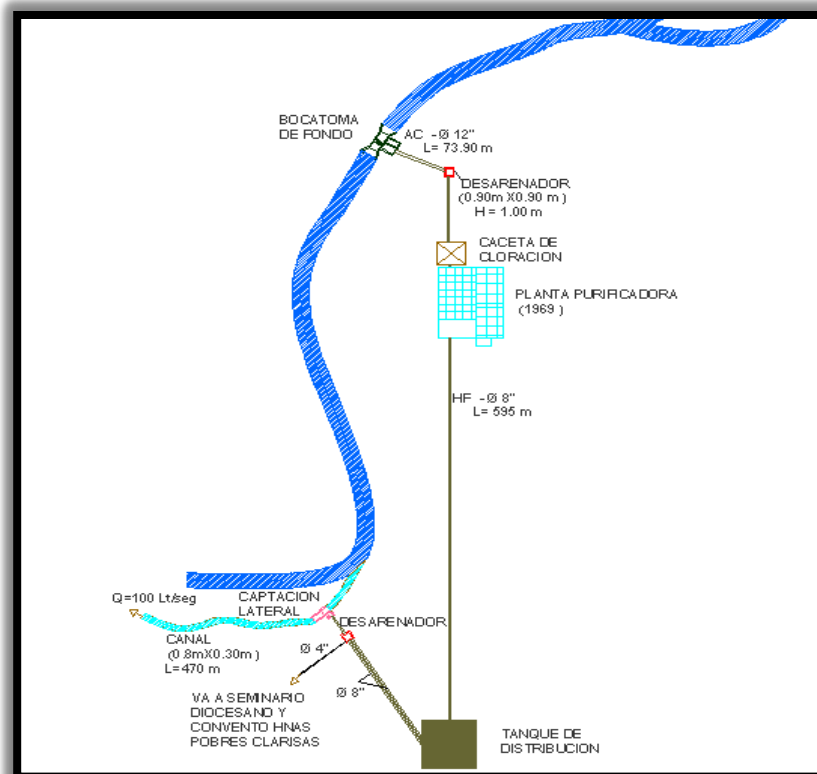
Construcción planta purificadora dentro del primer acueducto municipal
